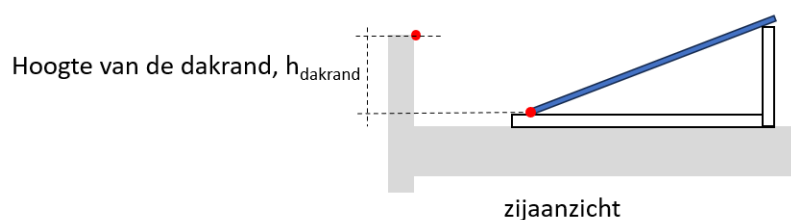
x2 Zichtveld voor panelen en collectoren bij belemmering door dakranden
